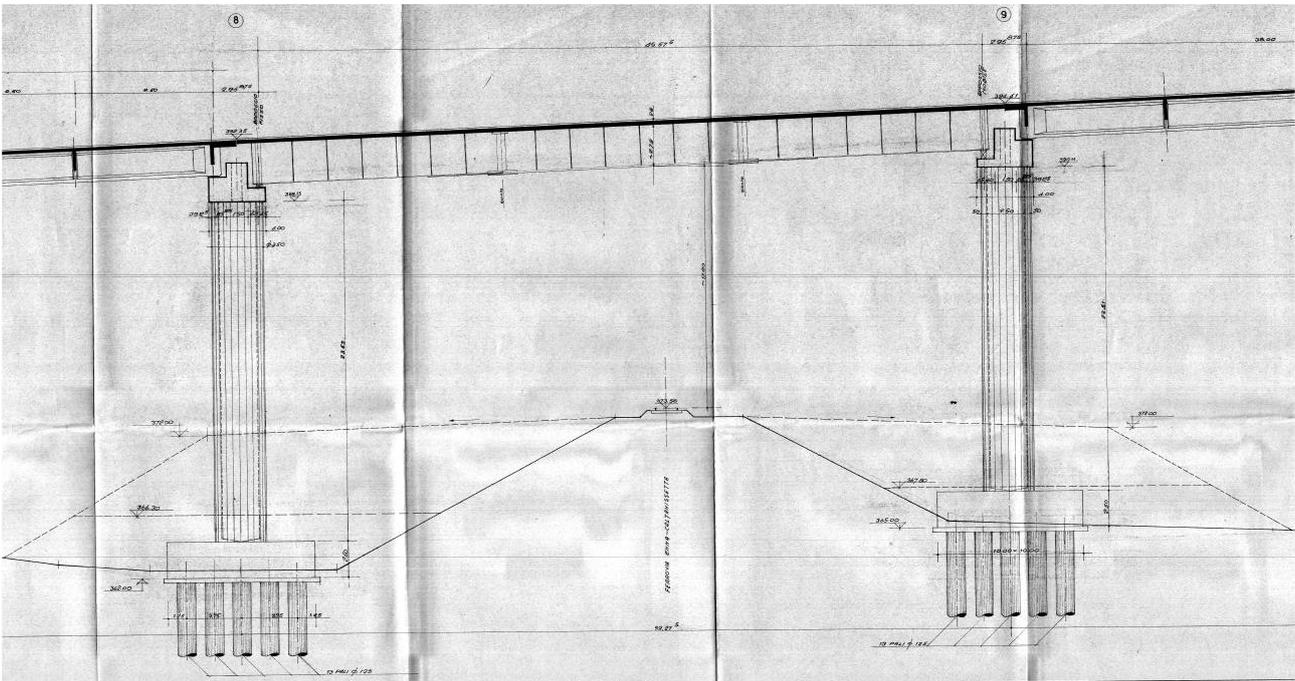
Campate di scavalco linea FS – Sezione longitudinale
